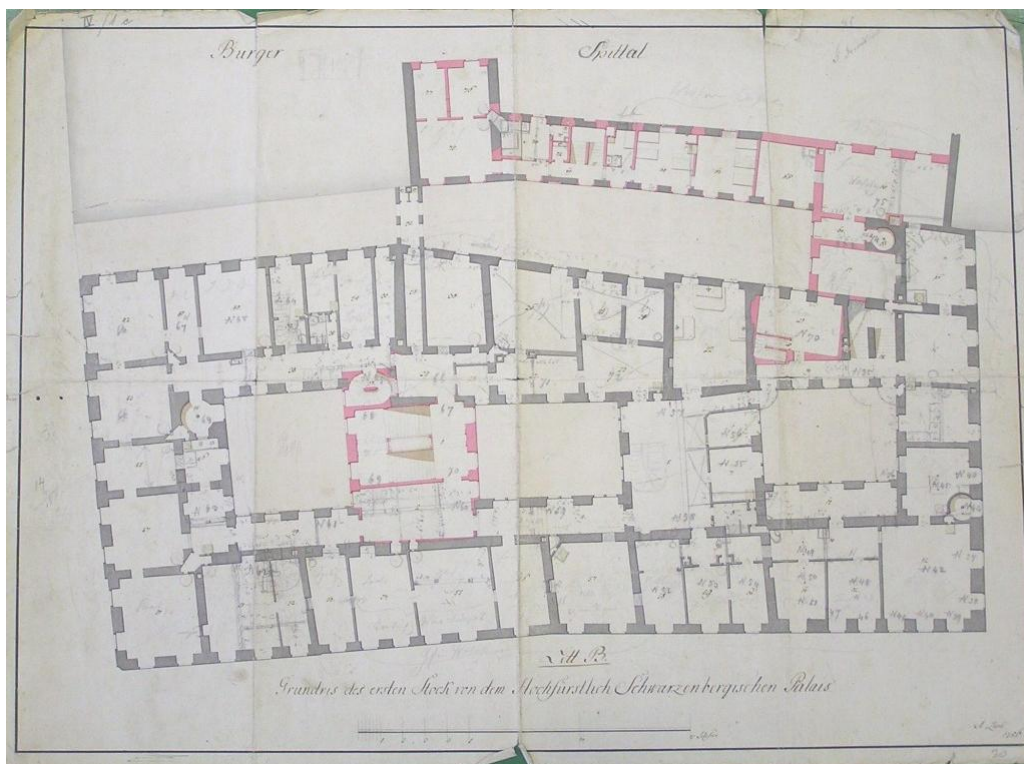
Ehem. Stadtpalais Schwarzenberg, Grundriss 1. Obergeschoss Litt. B,
